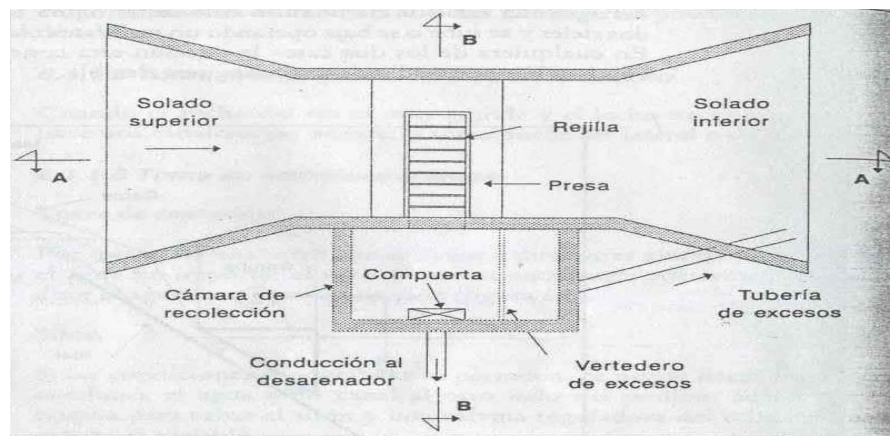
Bocatoma de fondo – Planta (López Cualla, 1995)
